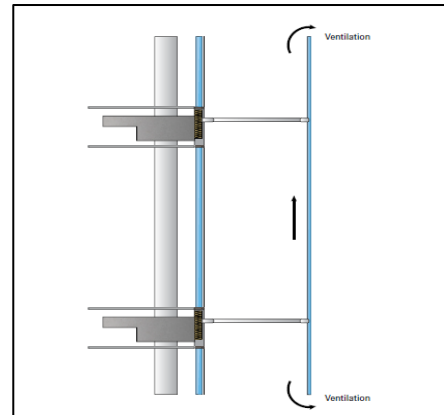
façades doubles peau ventilée sur plusieurs niveaux
